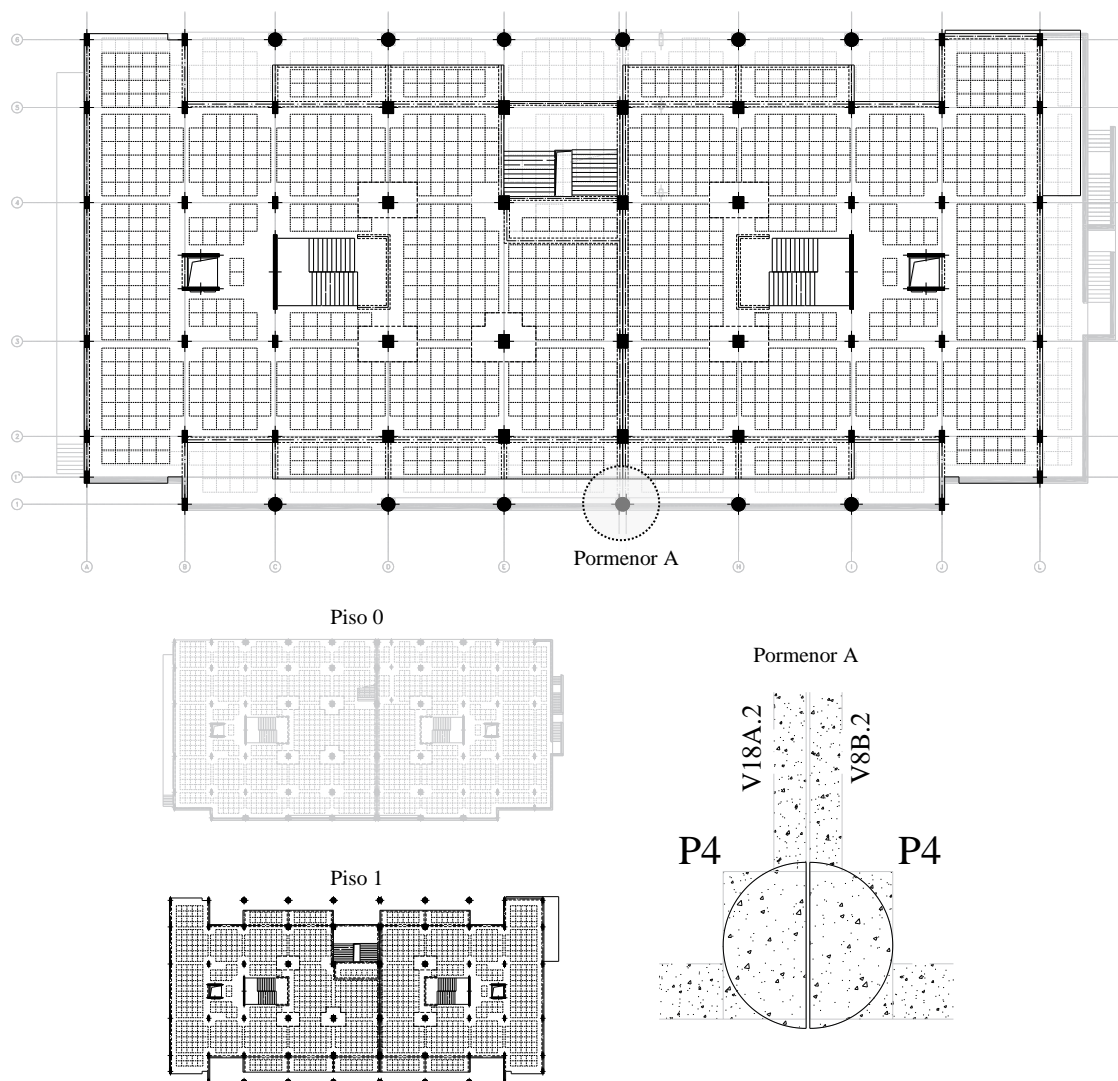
Planta do piso 1 sobreposta à planta do piso 0 com pormenor da junta de dilatação (pormenor A).
